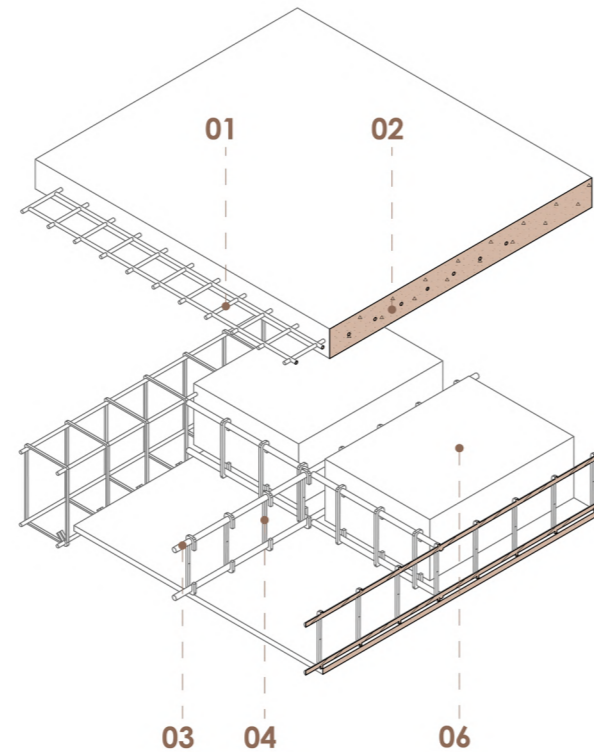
Armado de Losa nervada antes de verter hormigón
